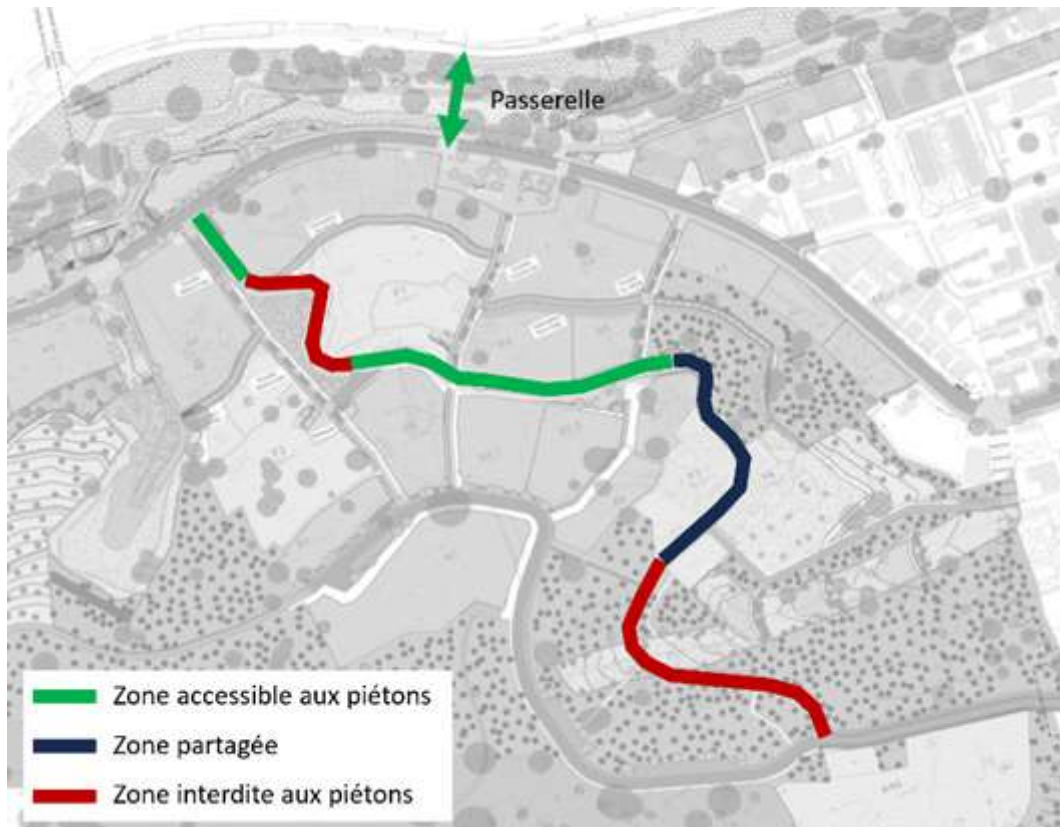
Plan de l'accessibilité de la rue des Coteaux de la ZAC de Doujani.
